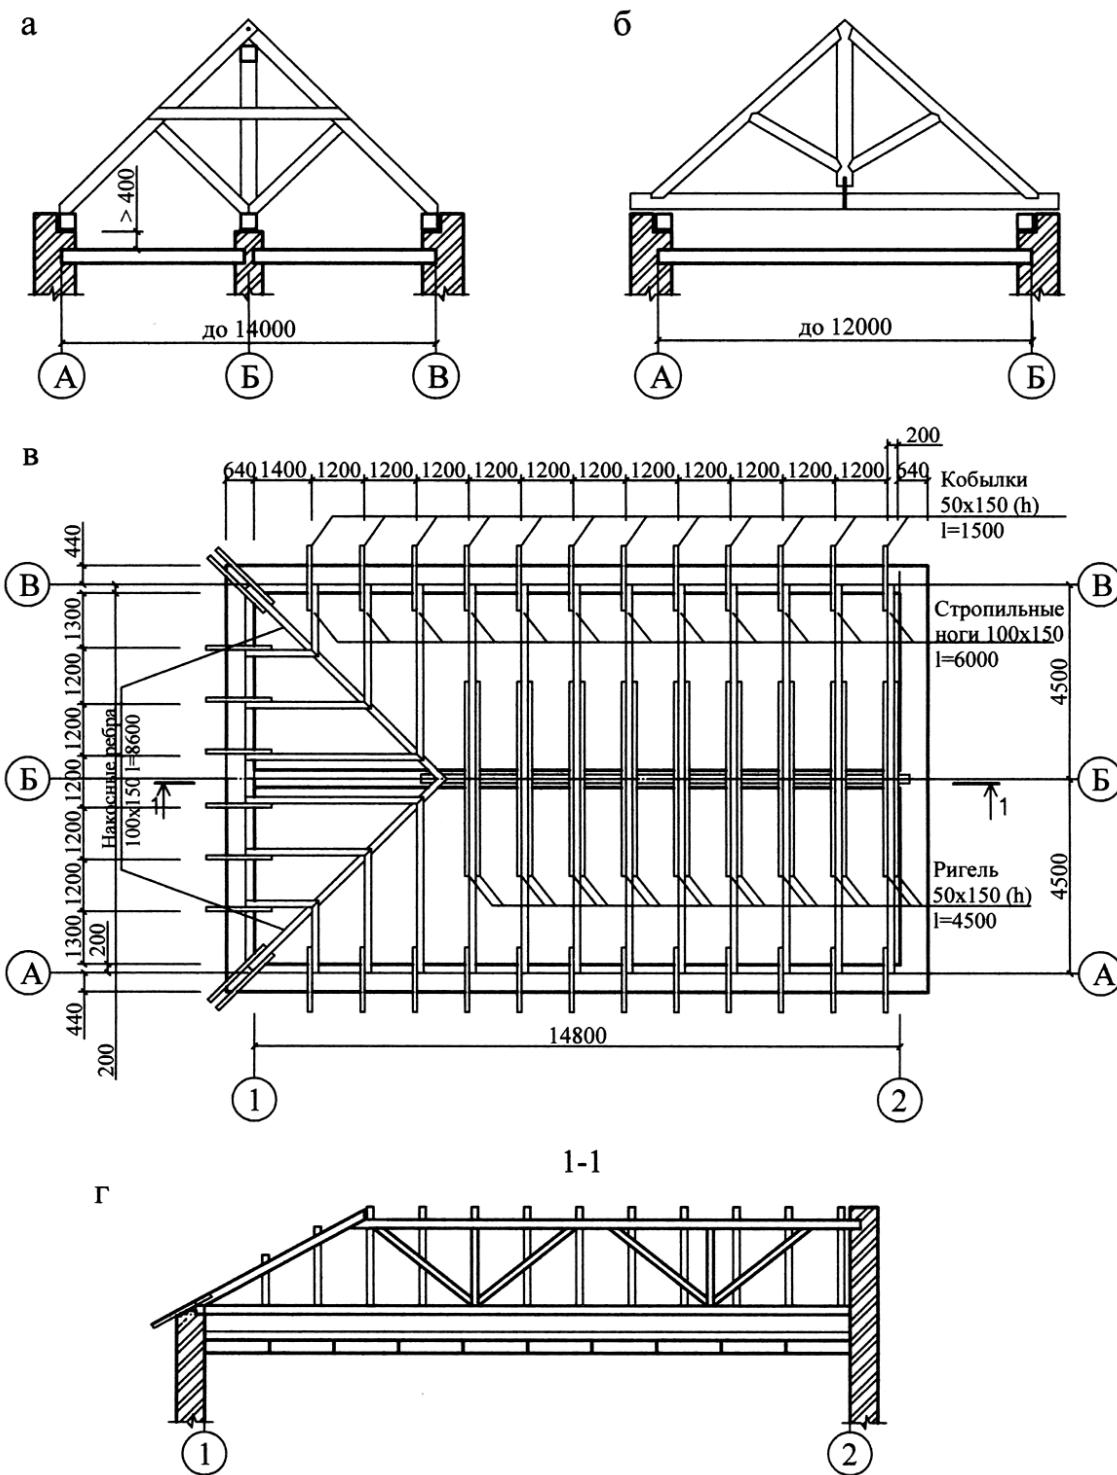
Стропильные конструкции малоэтажных зданий:
